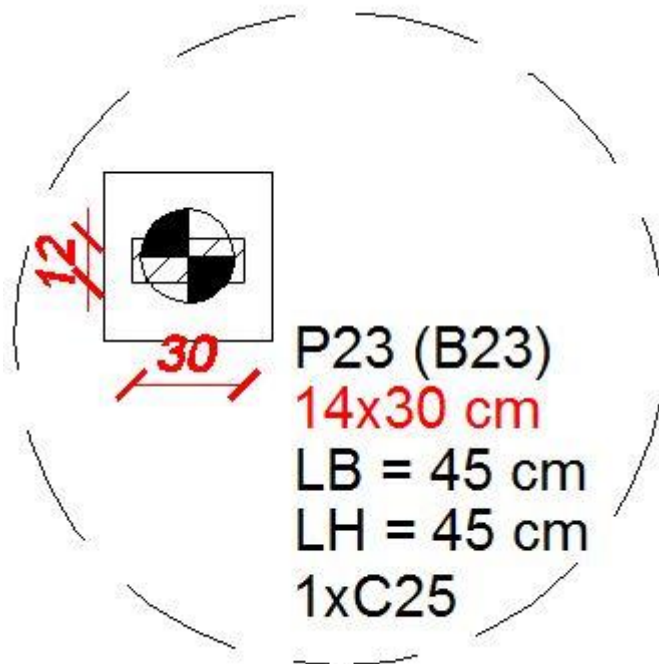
Detalhe do pilar P5 erro na legenda
